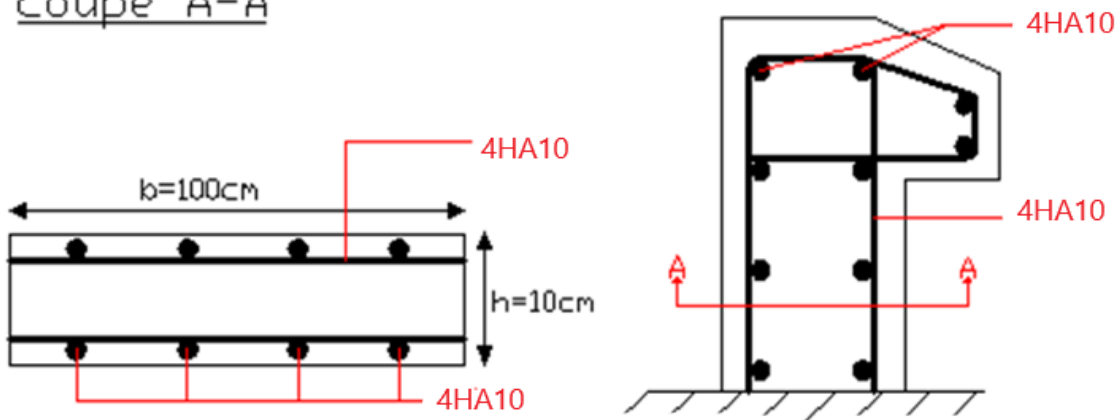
Schéma de ferrailage de l'acrotère.
